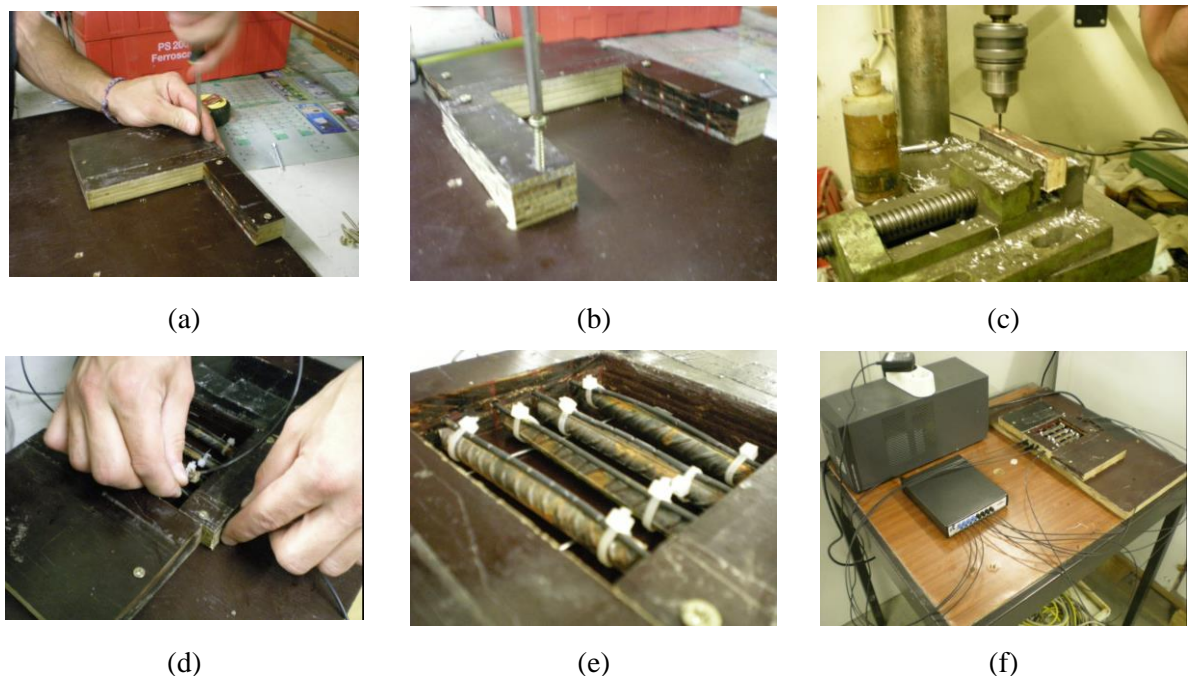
Cofragem: a) b) c) Preparação da cofragem; d) colocação dos sensores dentro da cofragem; e) perspectiva dos sensores dentro da cofragem; f) plano do sistema de ensaio.
